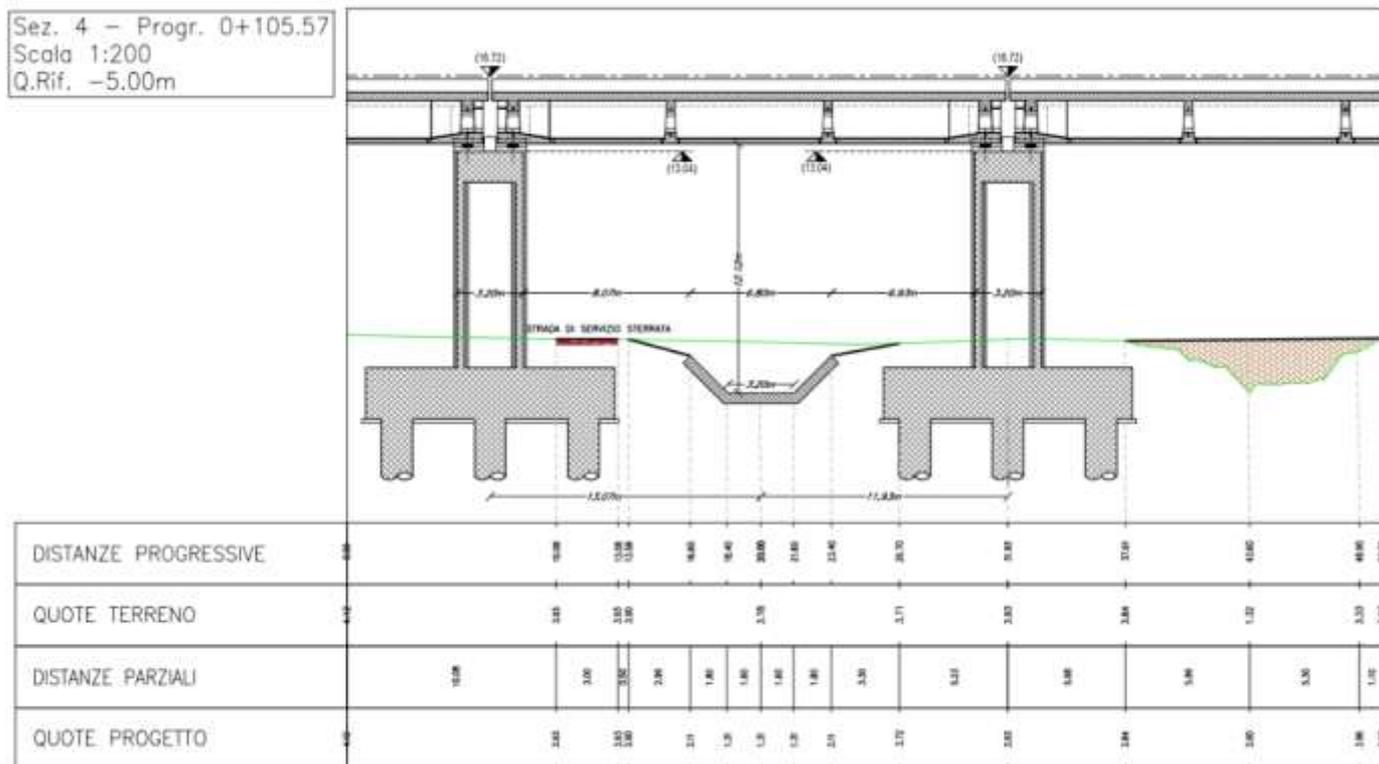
Sezione trasversale dell'opera alla pk 4+697,42 sotto il viadotto VI02 (da PD).
